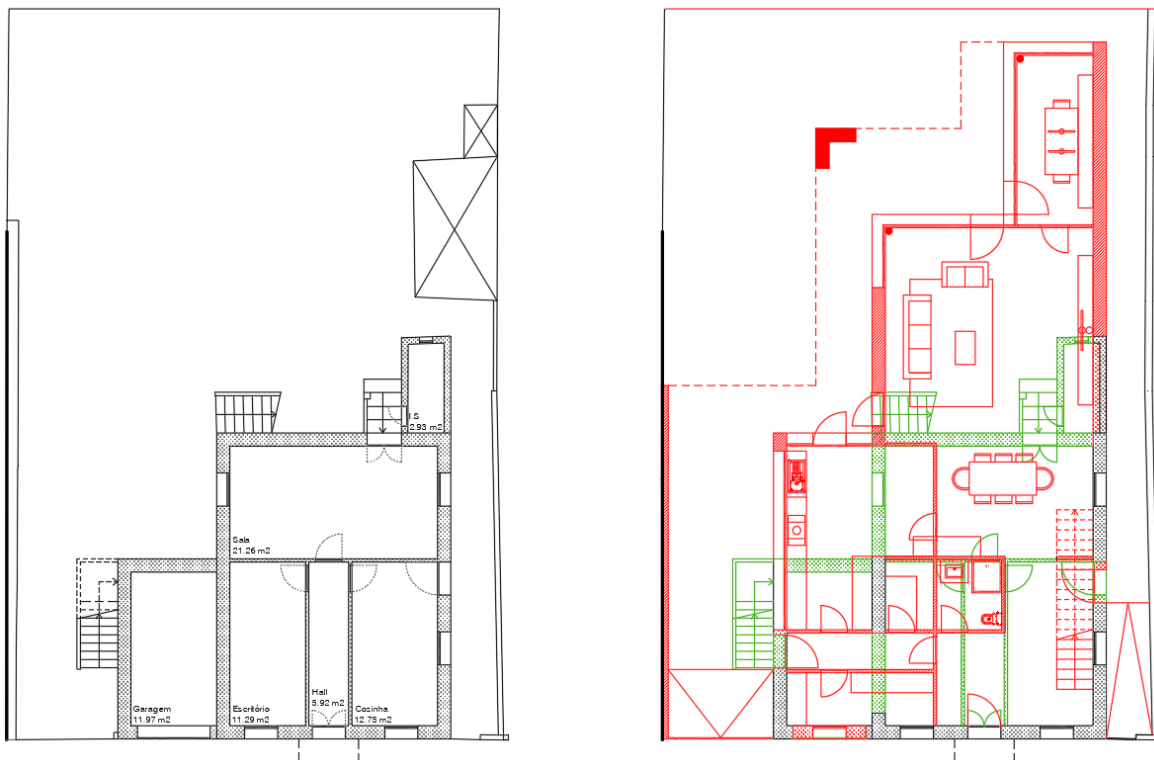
R/C planta antiga e R/C planta alterada (Projeto de arquitetura).
